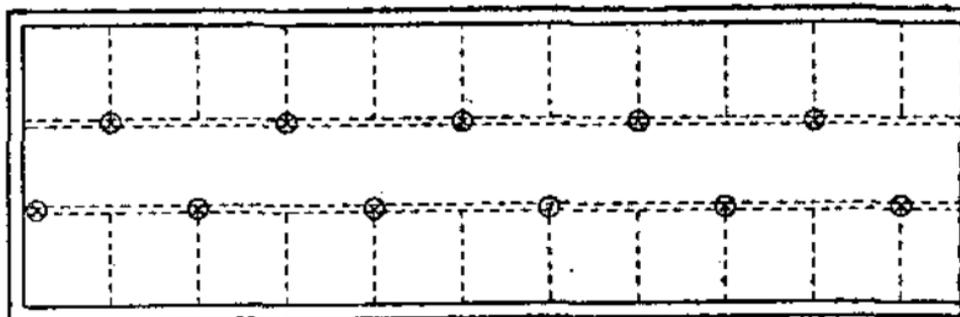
Размещение светильников в свинарнике с двухрядными станками.
